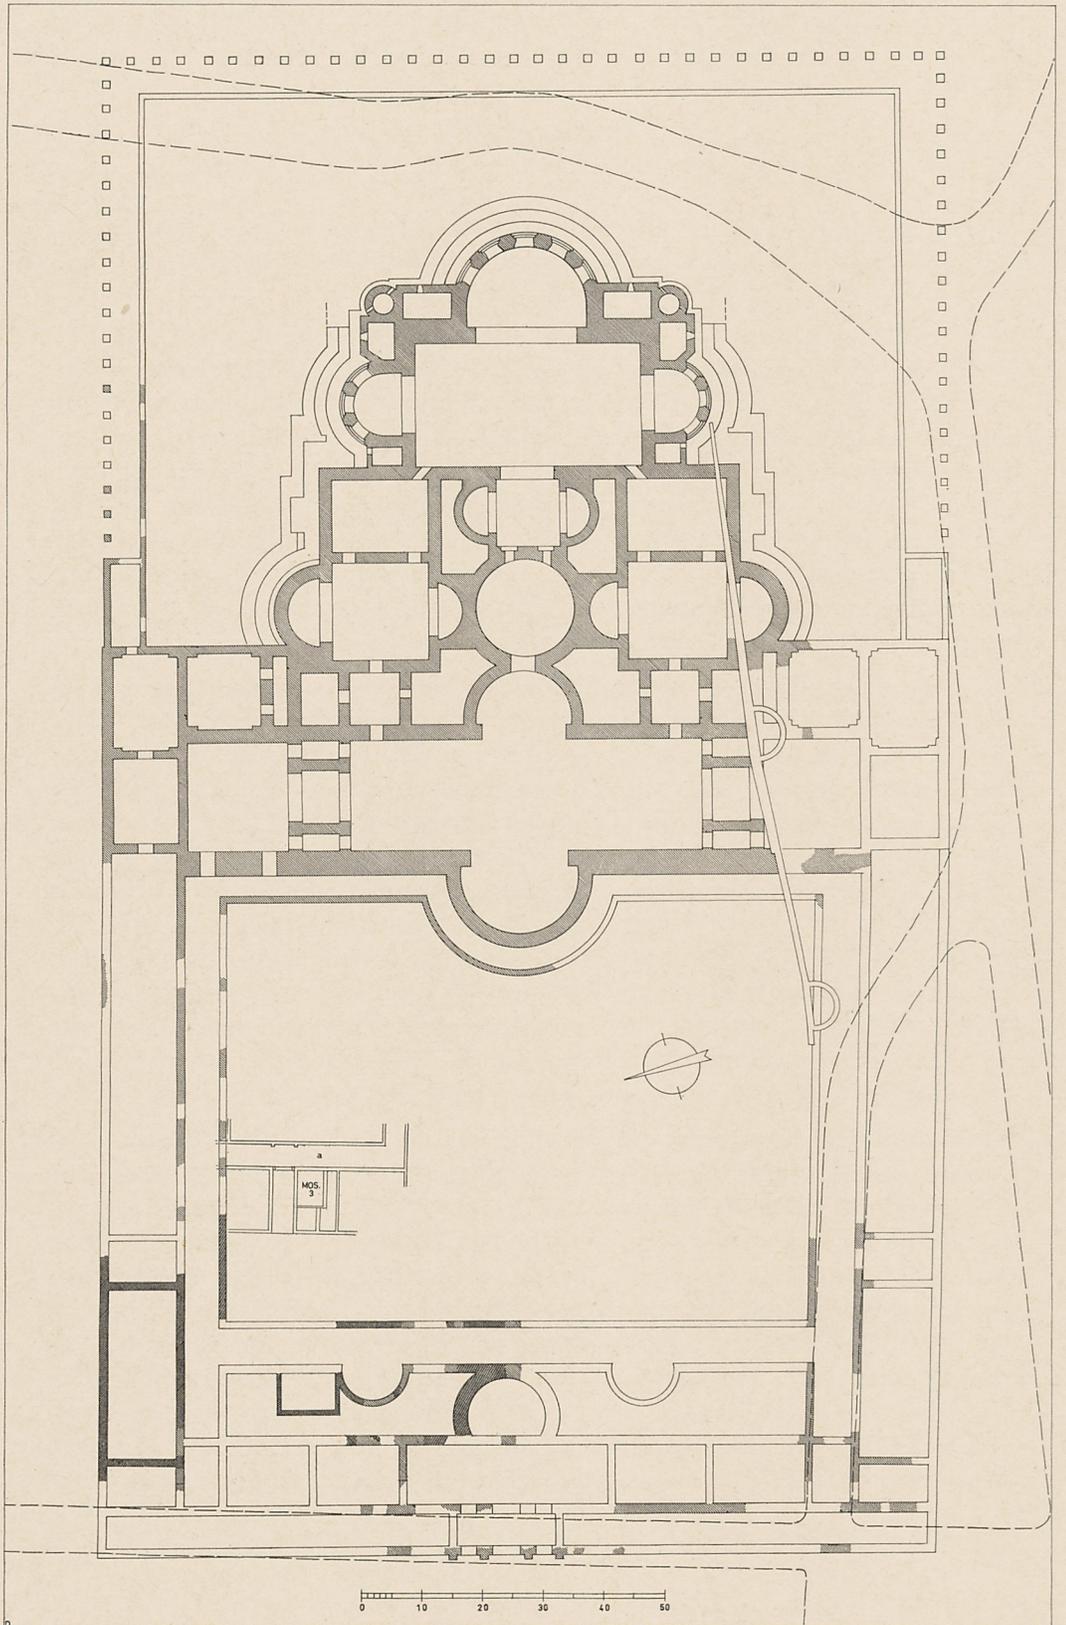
Trierer Kaiserthermen, Übersichtsplan. Lage (Teilgrundriß) des Peristylhauses im Palästra-Bereich
